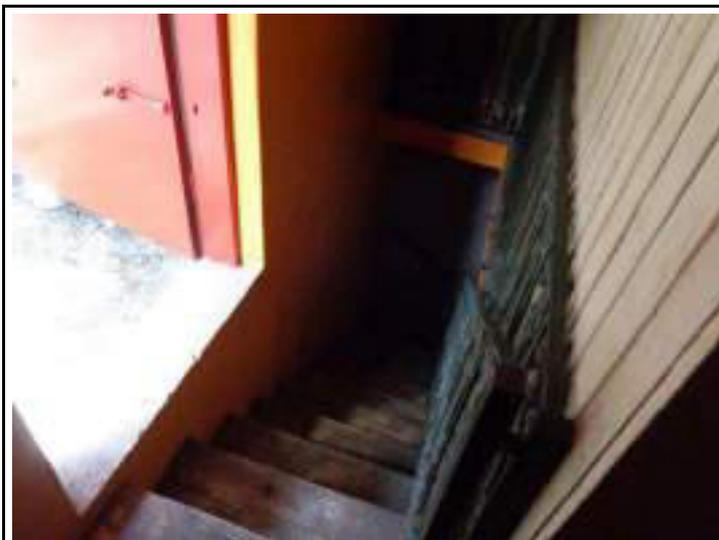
Vista de acesso ao depósito no pavimento inferior.
